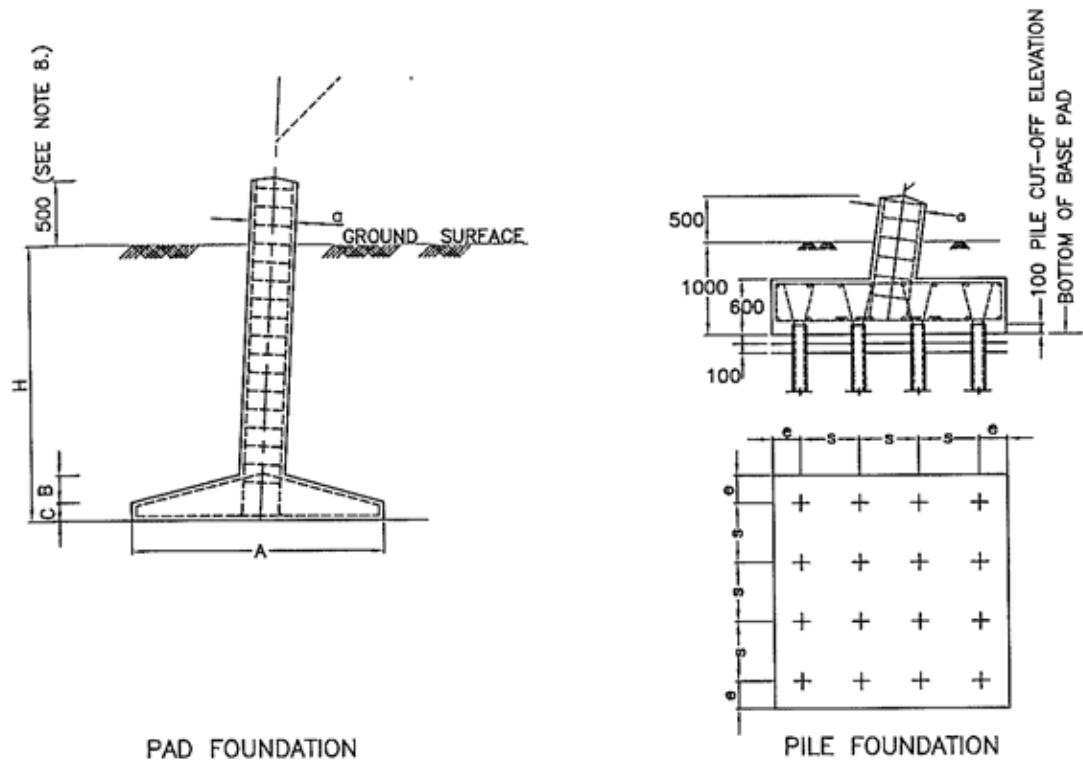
500 kV, Tower Foundation (Pad and Pile Foundation)
